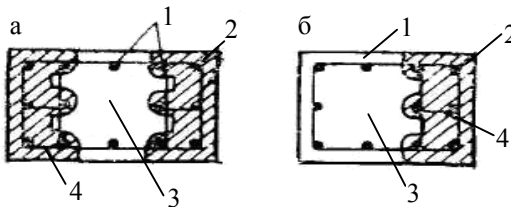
Схеми зміцнення колон зрощуванням перерізу:
